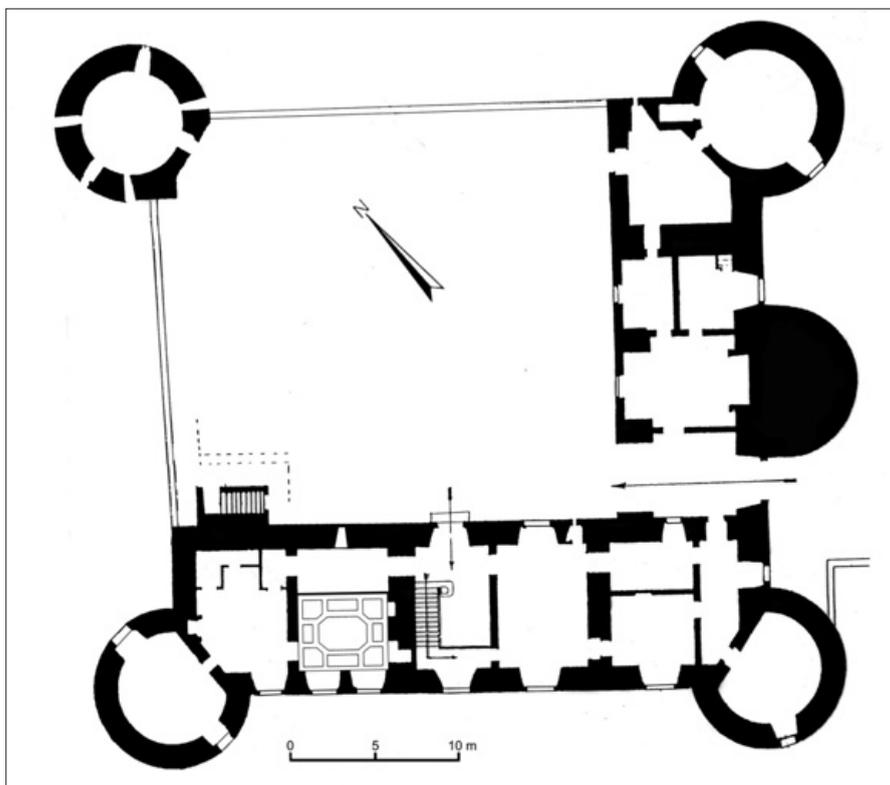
PLAN DU REZ-DE-CHAUSSÉE du château avec la position du plafond du cabinet.
